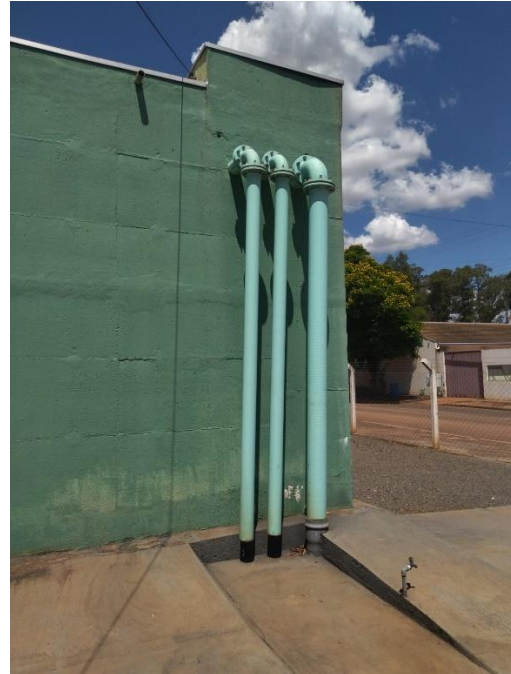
Falta de telas de proteção nos extravazores e ventilação.
